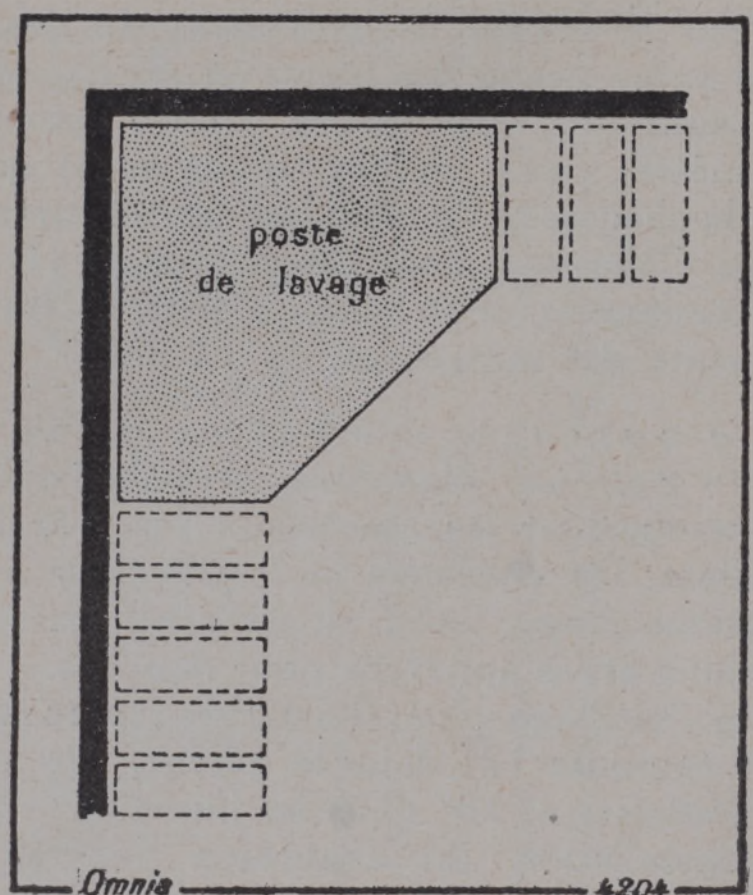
Fig. VI. — PLAN D'UN POSTE DE LAVAGE PLACÉ DANS UN ANGLE DE GARAGE.
